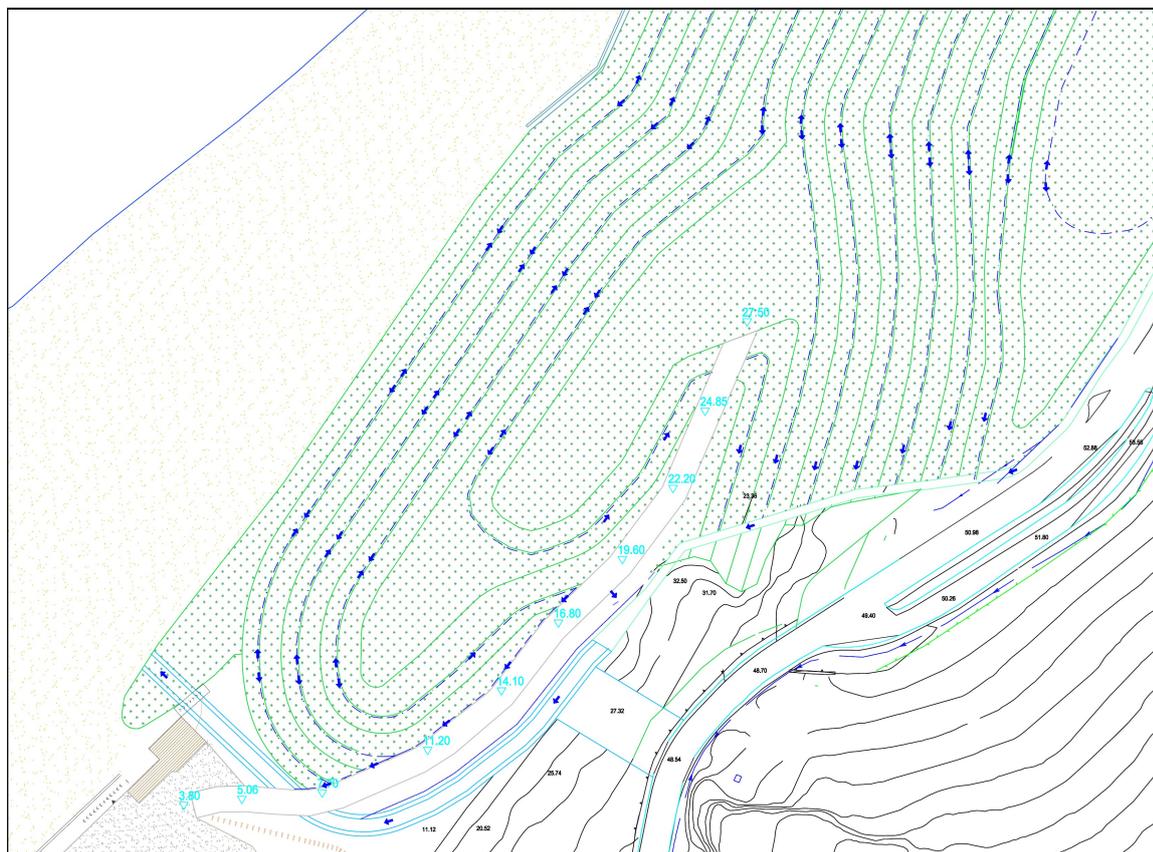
Planimetria dell'area camper con la rappresentazione delle opere in progetto
